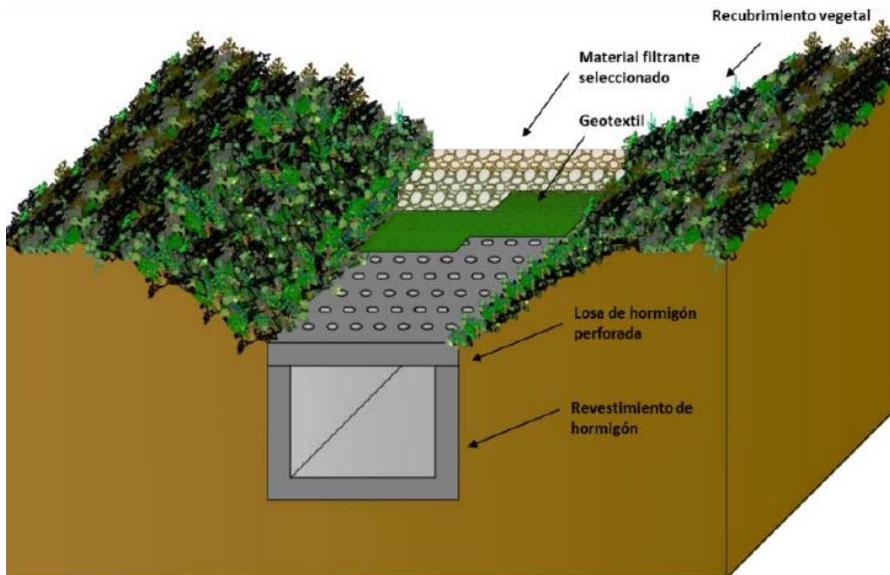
Sección tipo para la zanja drenante (IDOM, 2018)
